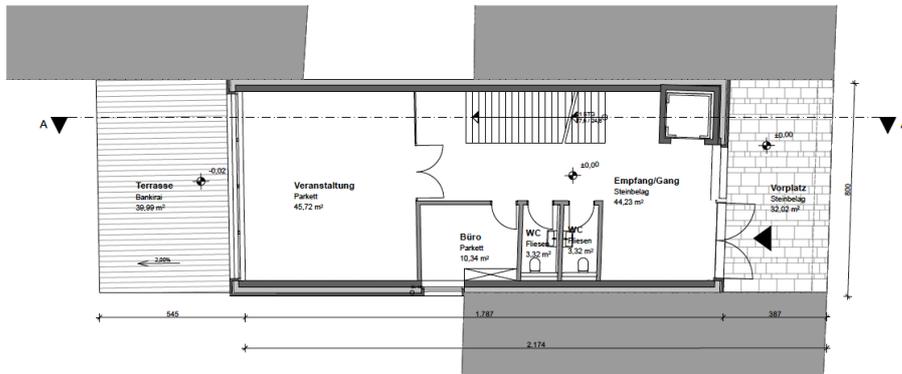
Entwurf Grundriss (Beispiel)⁹⁶
